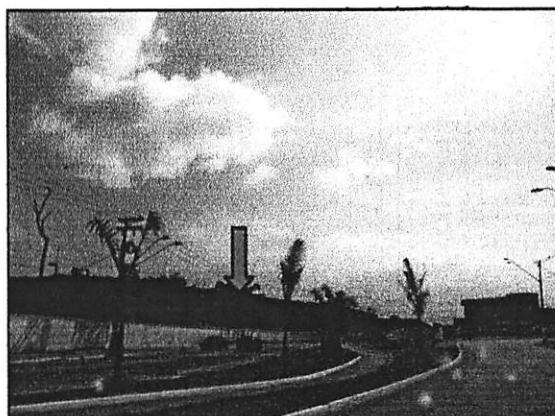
Observador na Av. do Trabalhador com vista para o aterro sanitário do "Lixão" onde se situa os lotes em estudos
